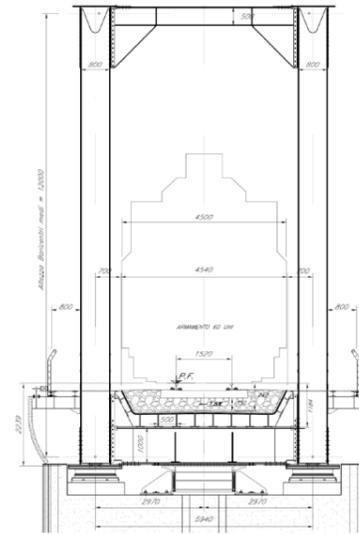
Sezione trasversale campata in acciaio L=70 - Singolo binario
